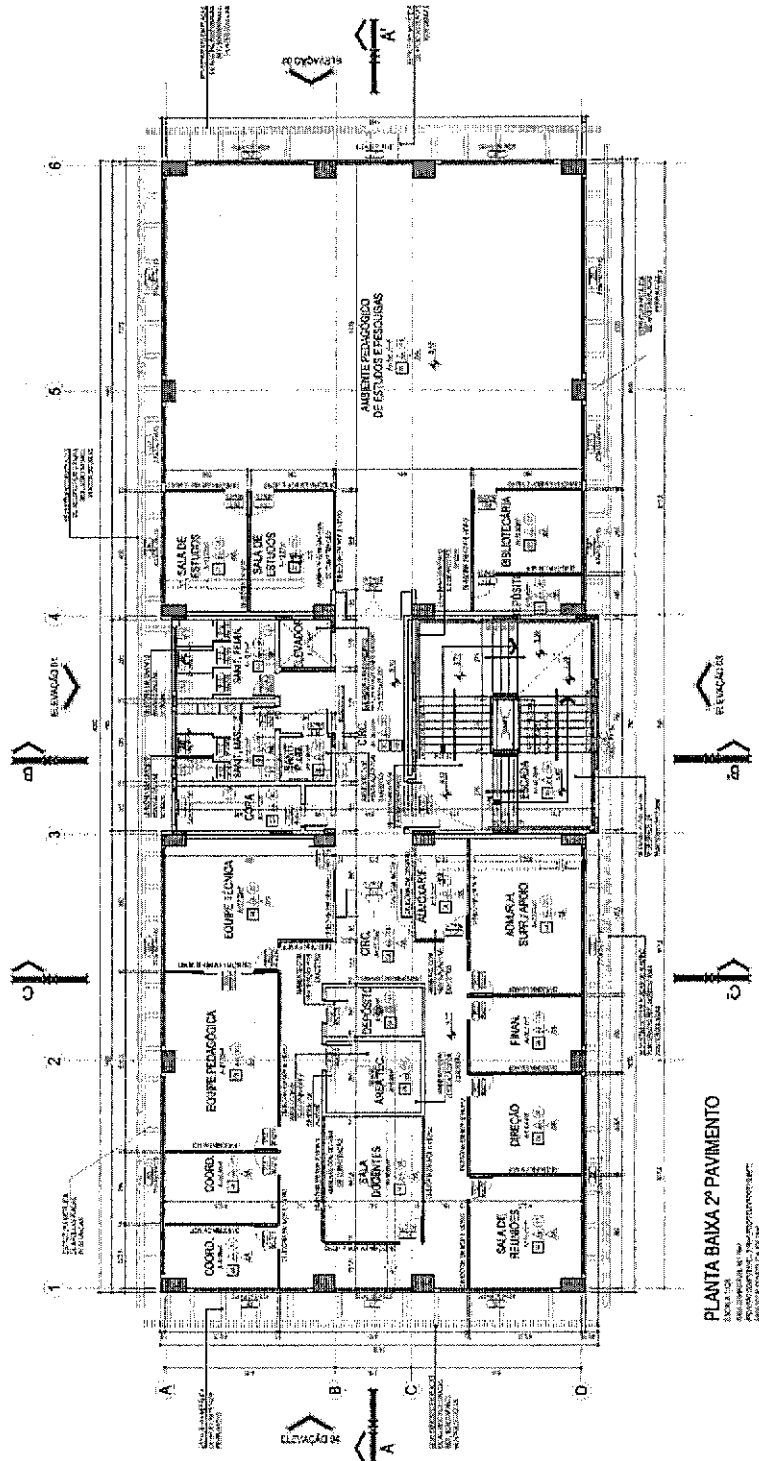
planta do 2º pavimento da obra SENAC Portão (CAT 4498/2016), pavimento com biblioteca e área de 621,10m². Obra de Construção.
